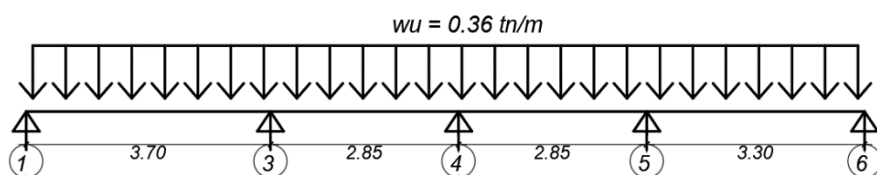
Modelo estructural de la losa aligerada
